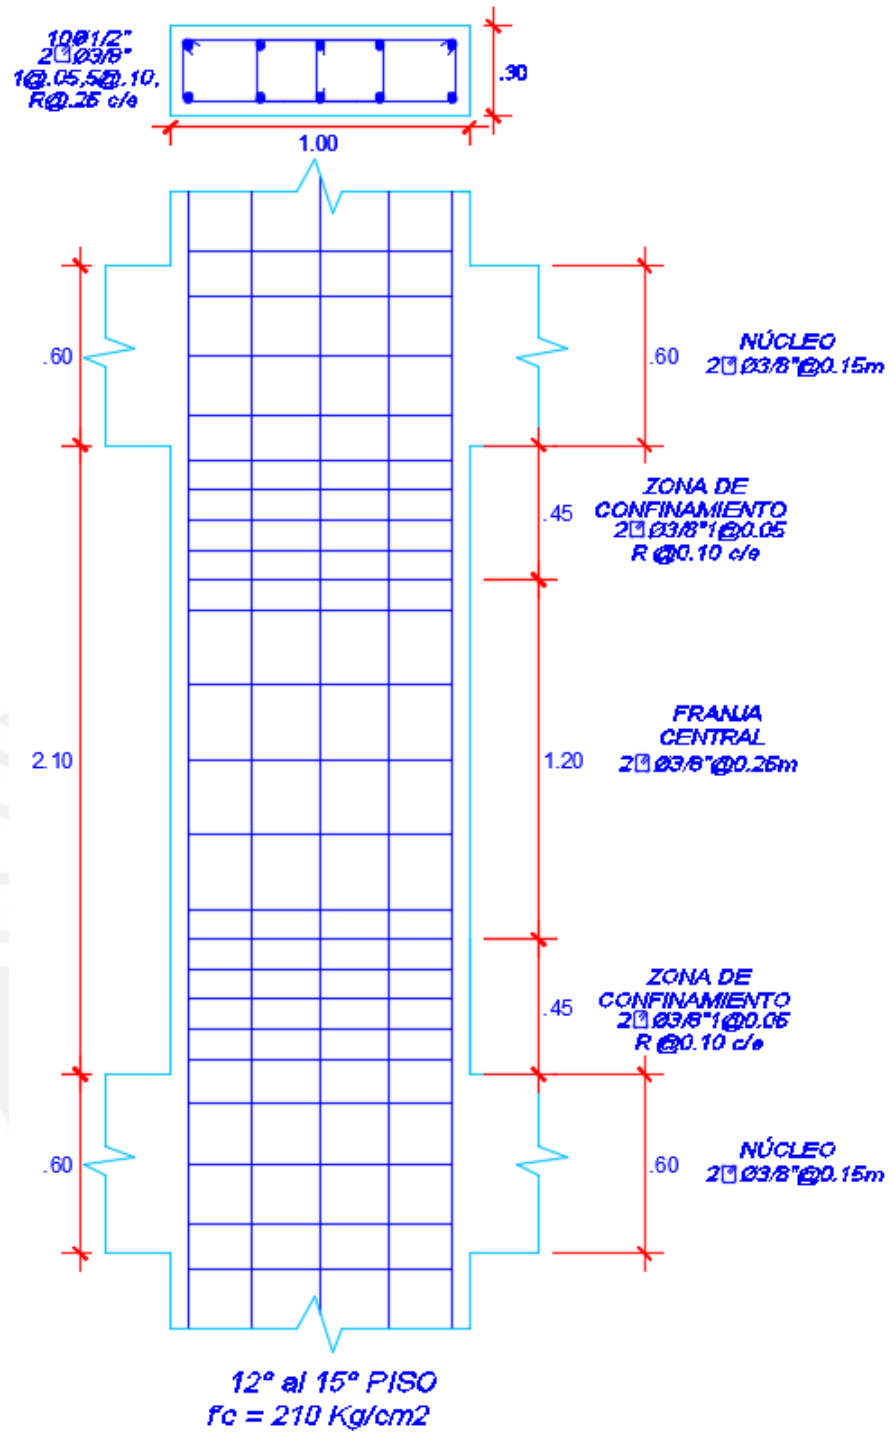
Esquema final de la columna C1 en AutoCAD 2016.
